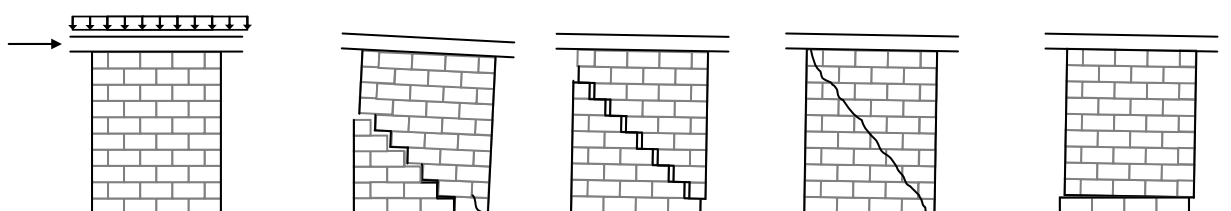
Versagensmechanismen von Mauerwerkswänden
